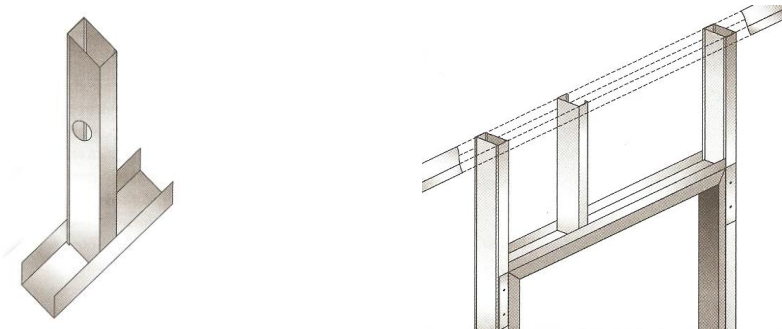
a) Montante duplo para maior rigidez na estrutura da porta e b) Conjunto que faz parte da estrutura de suporte da porta. Fonte: Drywall (2004)
